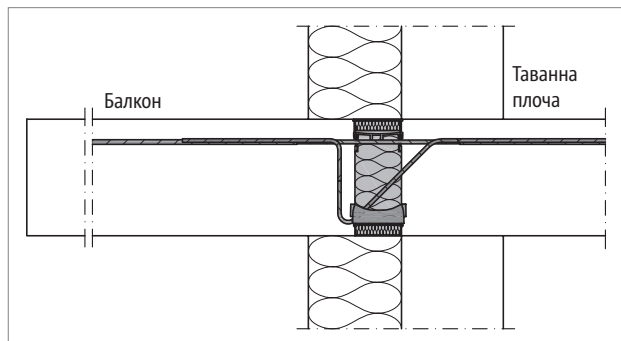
Schöck Isokorb® T mun KL и T mun QL: Балкон лежащ на три страни
